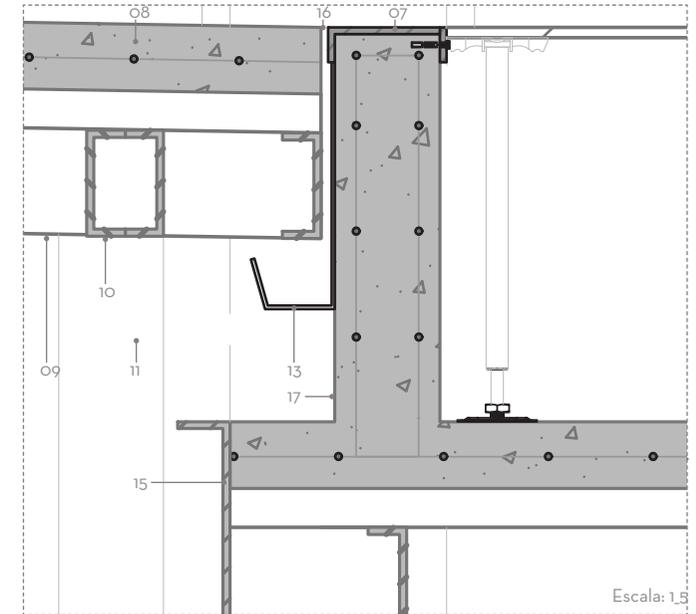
Det_e08. Junta entre Losa de vestibulo exterior y losa de piso técnico (Longitudinal)
